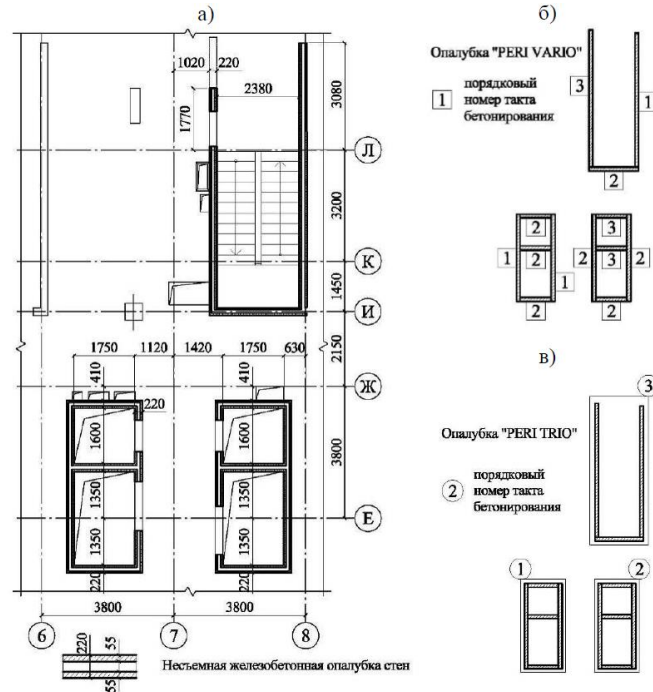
Схема расположения стен лестнично-лифтового узла: а) в сборно-монолитном исполнении; б) с разбивкой на рабочие смены при бетонировании стен в щитовой опалубке «PERI VARIO»; в) с разбивкой на рабочие смены при бетонировании стен в щитовой опалубке «PERI TRIO»
